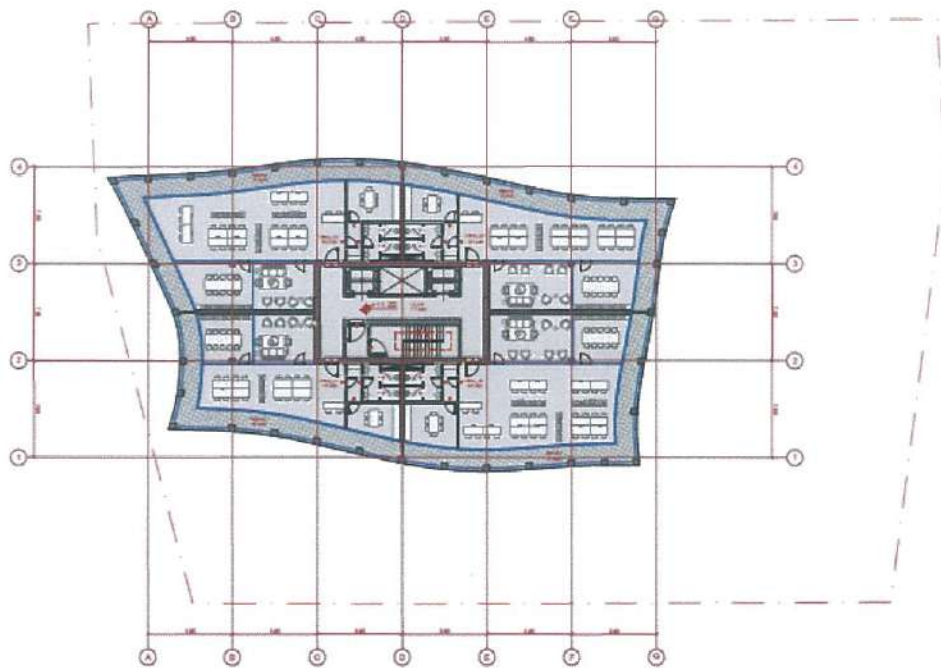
Planimetria e katit 2, në kuotën +11.22 SIP 891 m²
